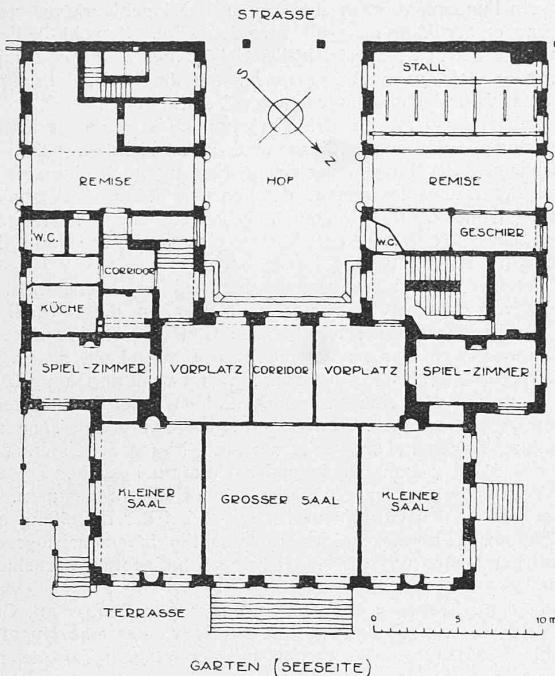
Erdgeschoss-Grundriss des Muraltenguthauses. — 1: 400.
